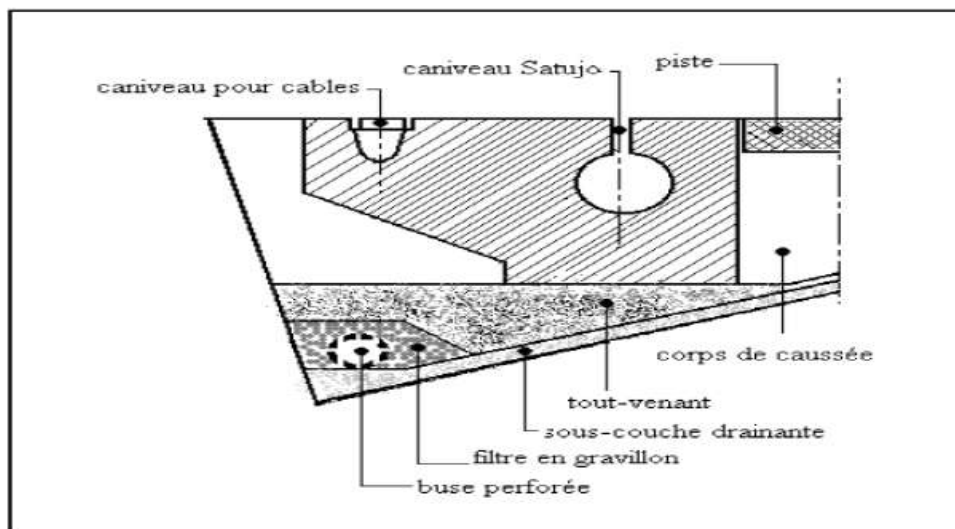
Exemple d'assainissement des eaux souterraines
